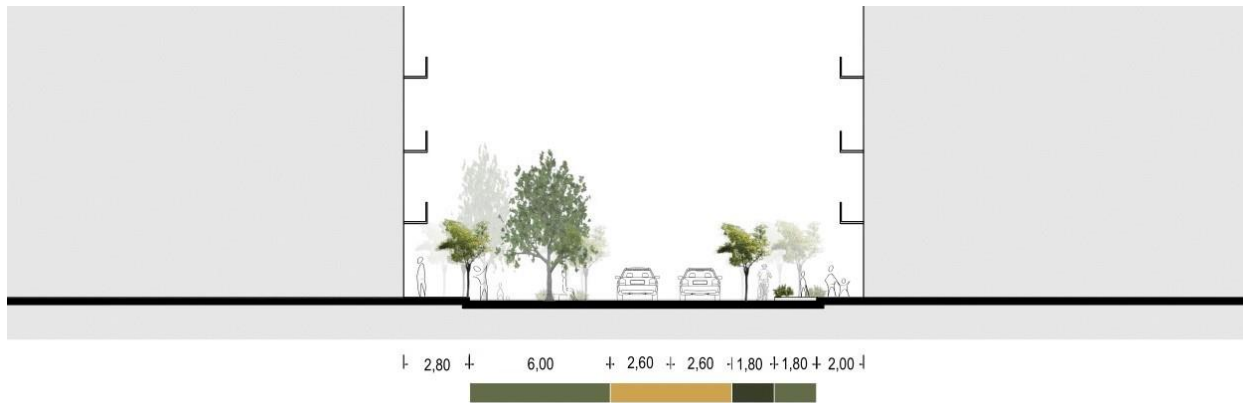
Sección esquemática sobre la nueva construcción, Bosque Urbano
